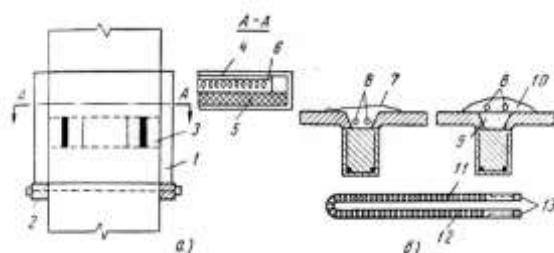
Электрообогрев стыков колонн и панелей перекрытия: а — теплоактивная опалубка для стыков колонн, б — электронагревательный прибор для стыков плит с балками; 1 — опалубка, 2 — хомут для поддержания опалубки, 3 — бетон, 4 — стенки опалубки, 5 — минеральная вата, 6 — электроспираль, 7 — брезент, 8 — нагревательный прибор, 9 — бетон стыка, 10 — опилки, 11 — нихромовая проволока в изоляционной пасте, 12 — металлическая трубка, 13 — клеммы термос с ускорителями твердения - заключается в использовании смесей с химическими добавками, понижающими температуру замерзания жидкой компоненты бетонной смеси, обеспечивающими твердение бетона при температуре ниже  $0^{\circ}\text{C}$  и таким образом увеличивающими время, в течении которого бетон может набирать прочность.
